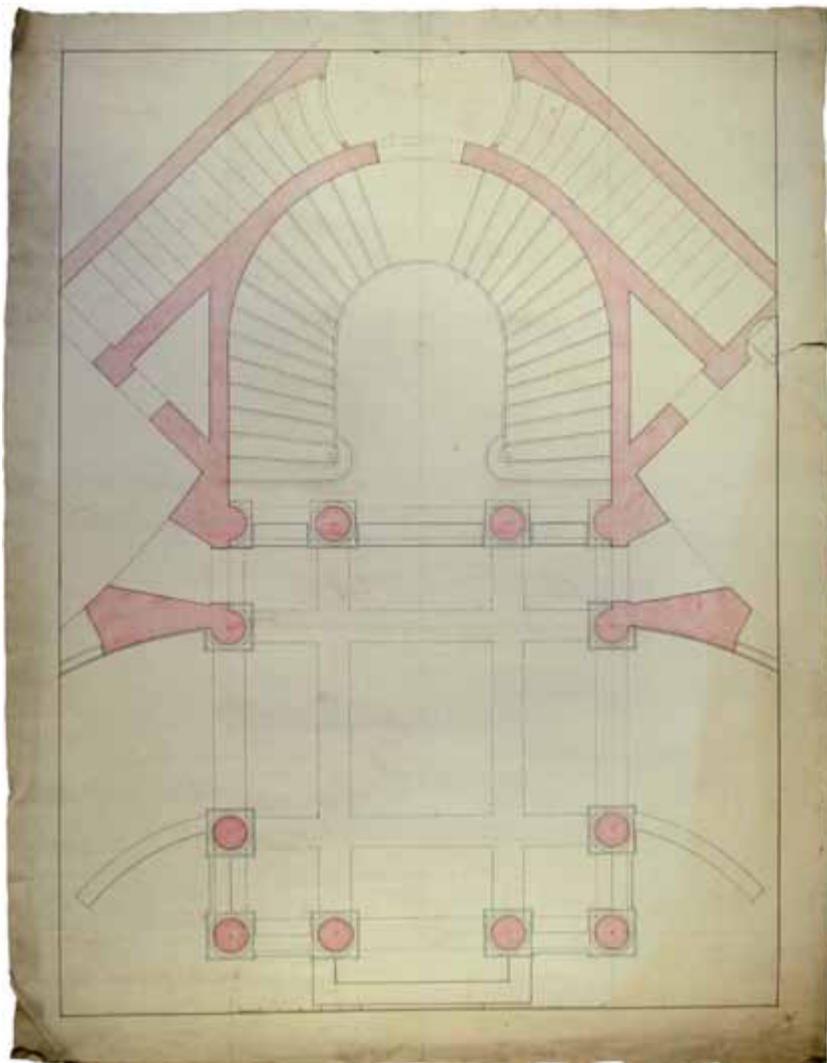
Projet de château d'Enghien à la Cense, plan de l'entrée et de l'escalier (Archives Générales du Royaume).
